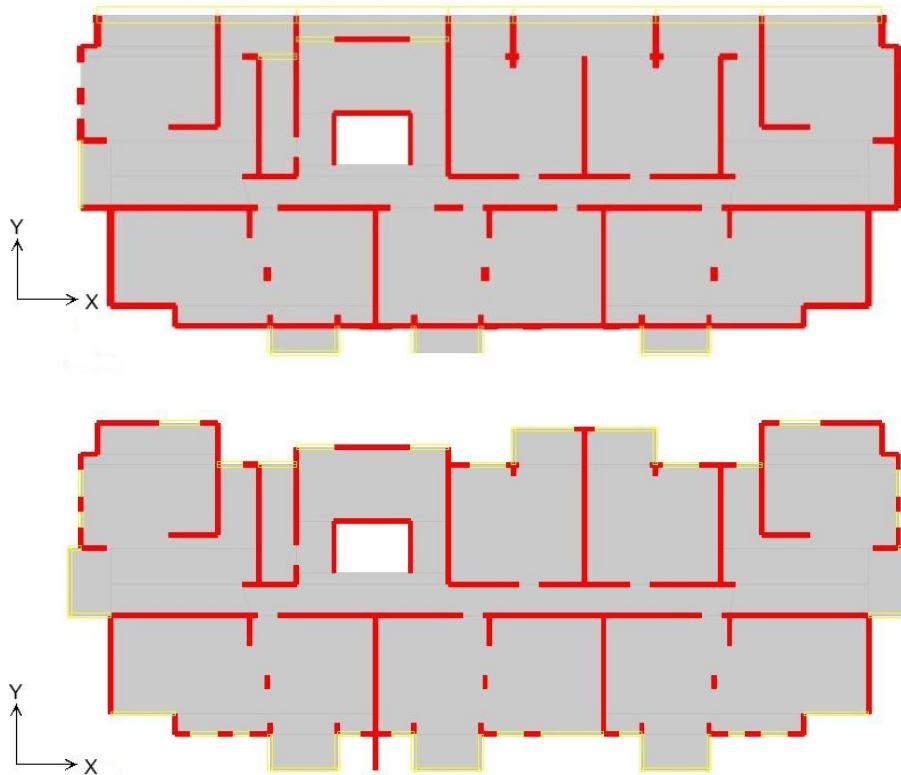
Planta primer piso (arriba) y piso tipo (abajo) edificio H3
